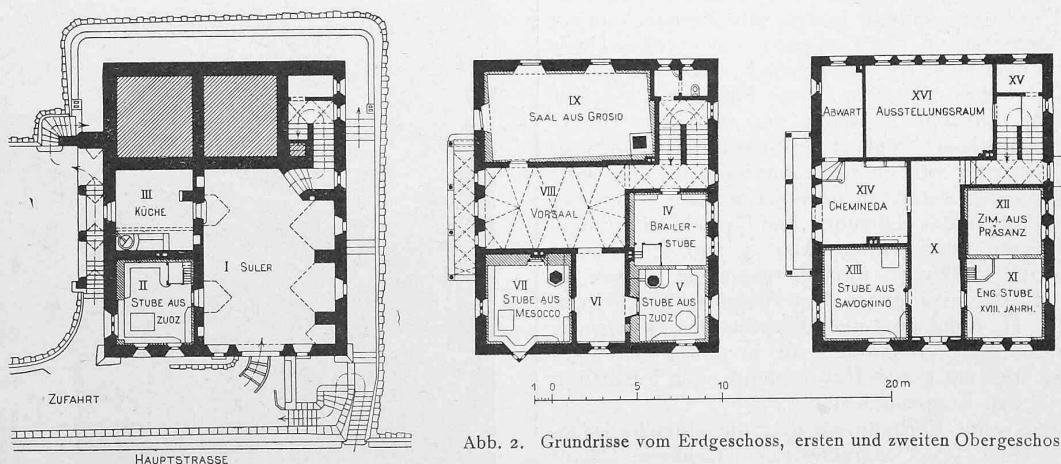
Grundrisse vom Erdgeschoss, ersten und zweiten Obergeschoss. — 1 : 400.
